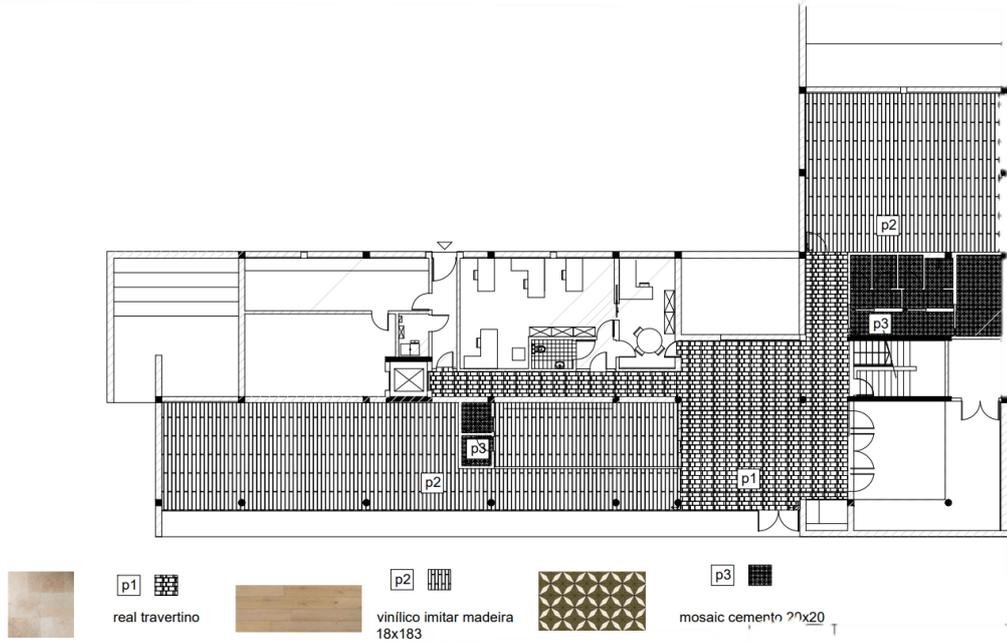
Planta de pavimentos piso 0 Fonte: Catarina Almeida Moita
